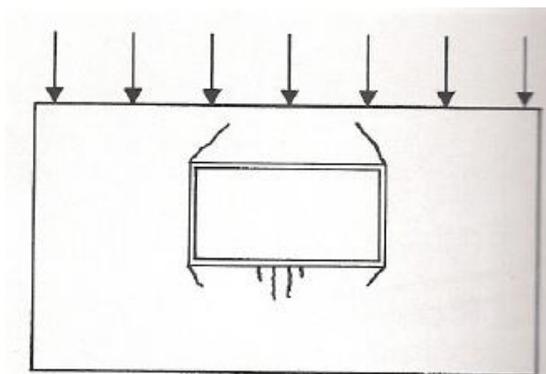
Fissuração típica no encontro de abertura em parede solicitada por carga vertical
